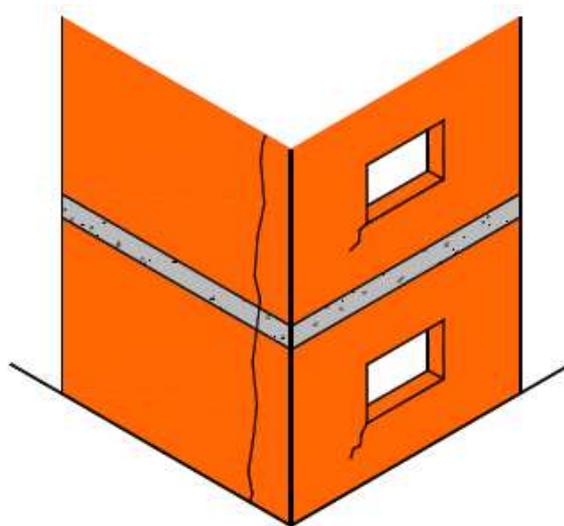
Fissuração vertical da alvenaria no canto do edifício provocada por movimentações higroscópicas (Fonte: THOMAZ, 1989).
